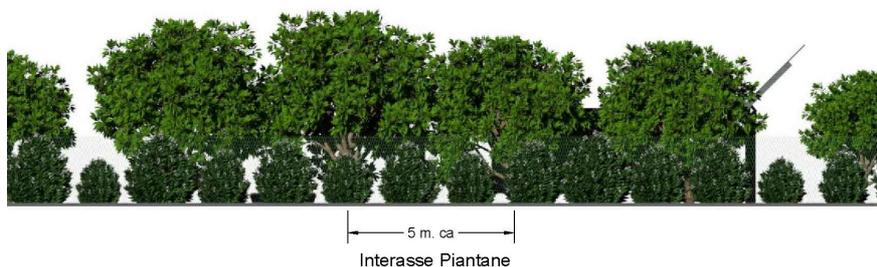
Prospetto recinzione perimetrale con mitigazione
